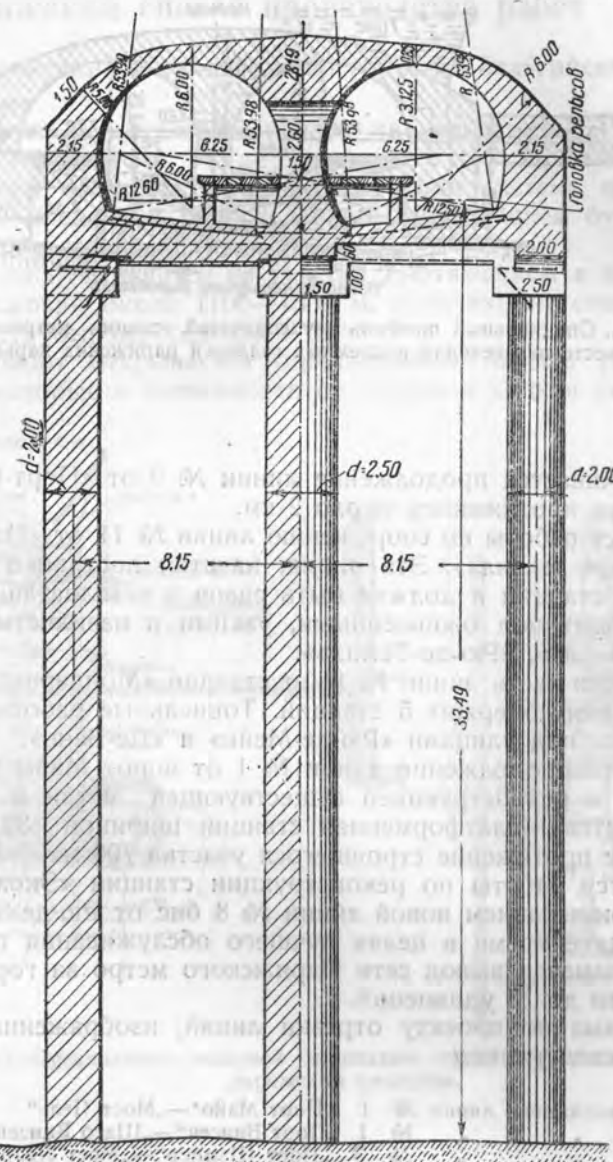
Конструкция тоннеля - моста станции Парижского метрополитена, фундаментного на столбах до надежного грунта через подземные карьеры.
